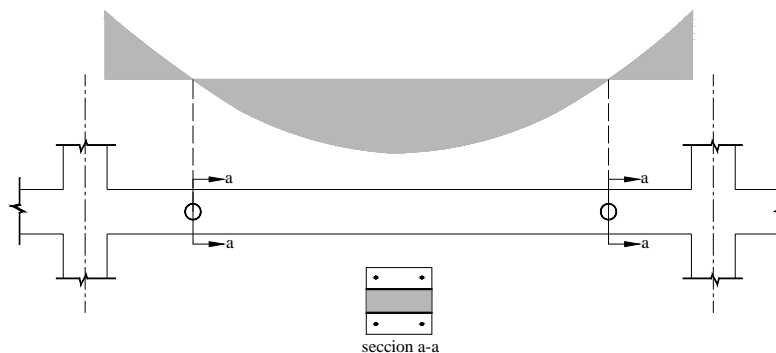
Tubería atravesada por una viga por donde el momento producido por las cargas muerta y viva es cero.
